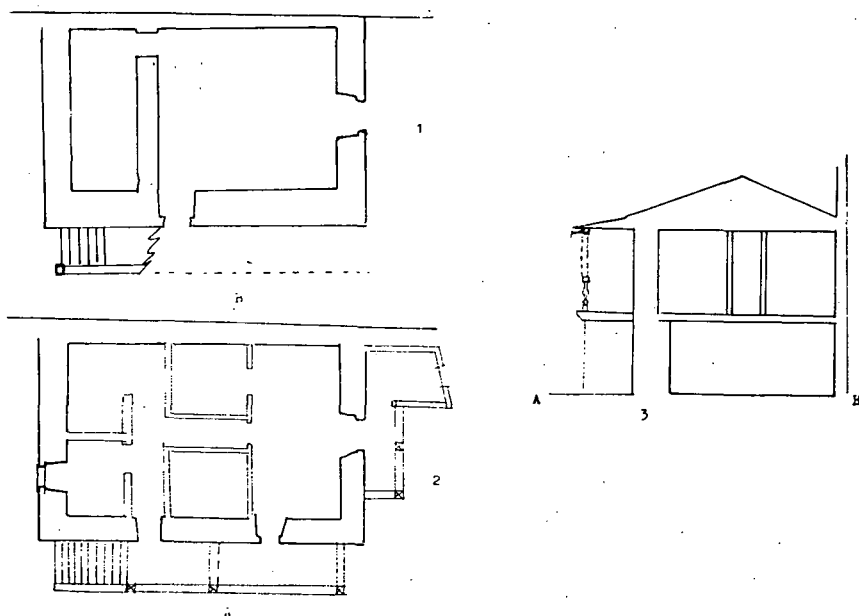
1. Planta baja. 2. Planta alta. 3. Sección vertical por A-B. Sobre dibujo del arquitecto E. Sala, que se guarda en el Museo de Pontevedra
